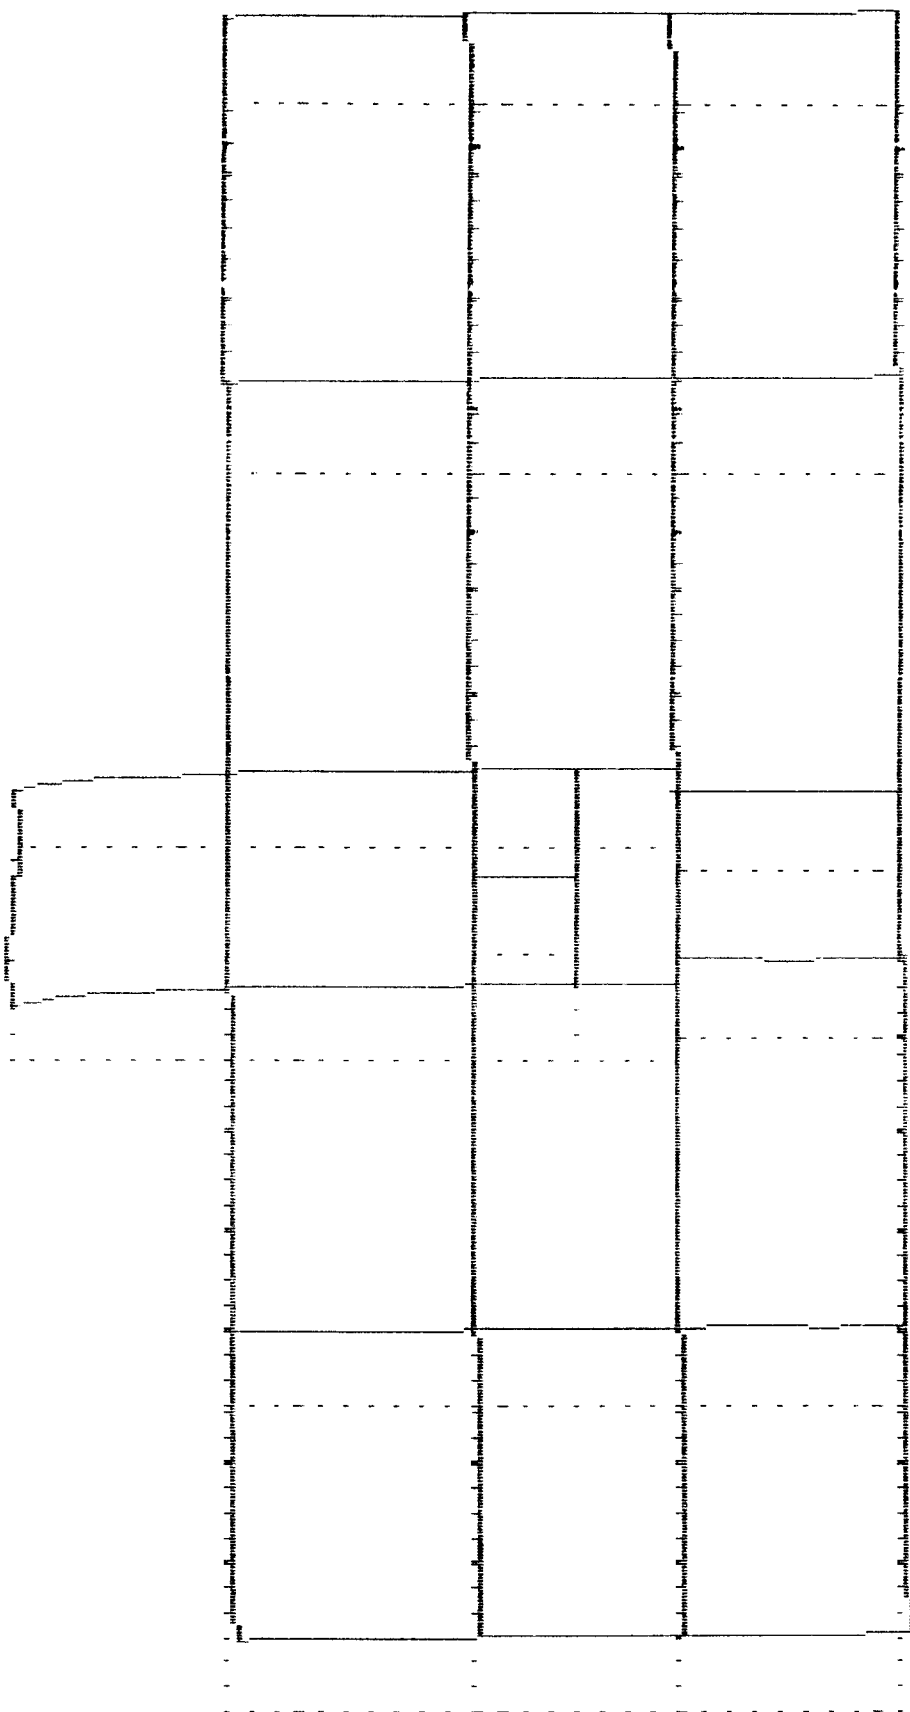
Vista em planta da posição deformada do 1.º pavimento devido à ação de vento atuando segundo a direção X
